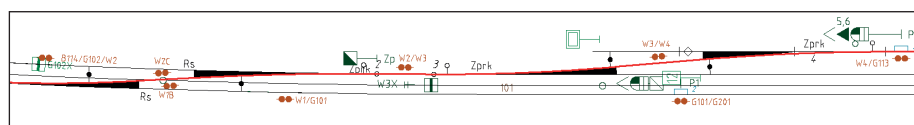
Ausschnitt eines rot markierten Fahrweges im Lageplan
